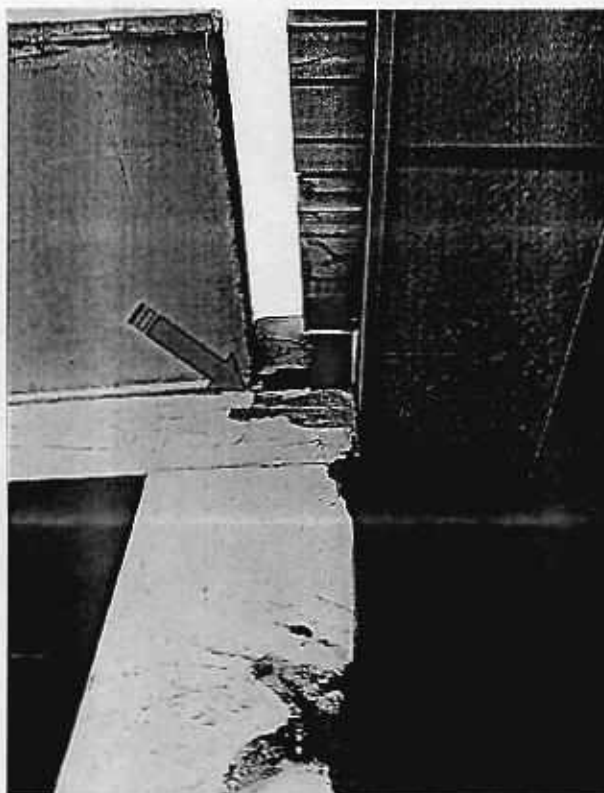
Se observan deterioros en acabados en la edificación de material noble afectando columnas en un primer piso
